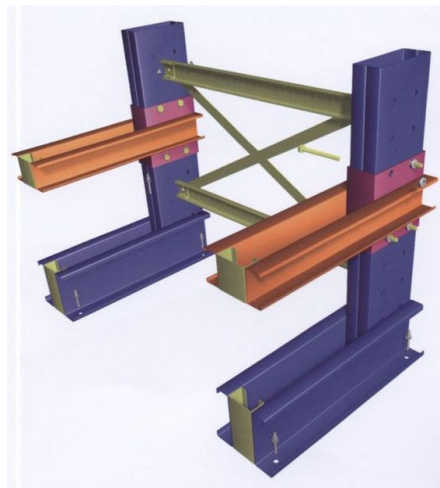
Elementos de estabilização do sistema *cantilever*, (Isma, 2005).
